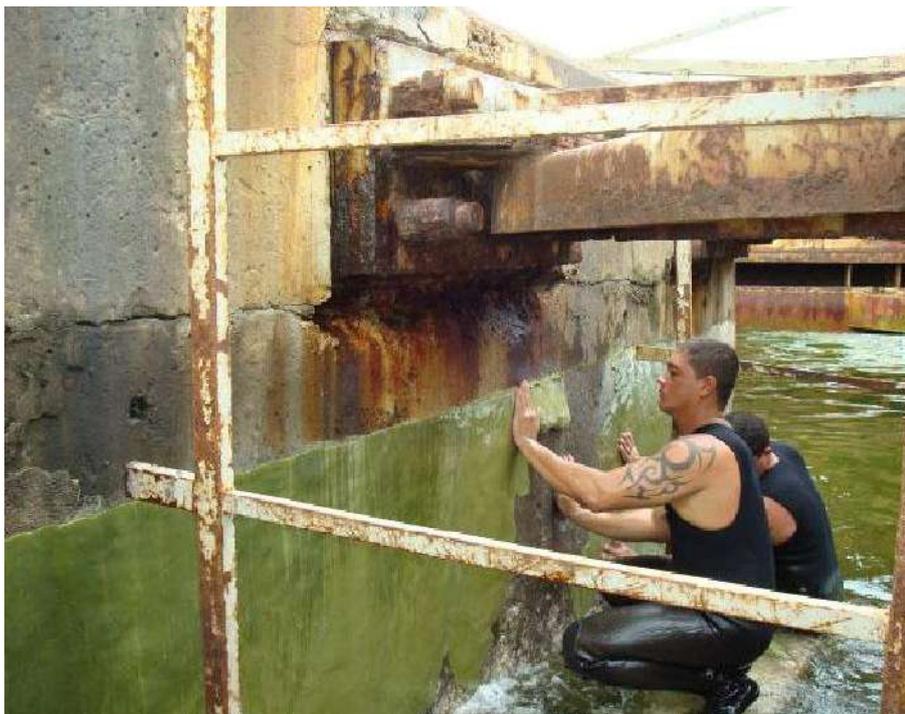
Aplicação de resina epoxídica para proteção do concreto em porto . Foto vitserv.com.br
